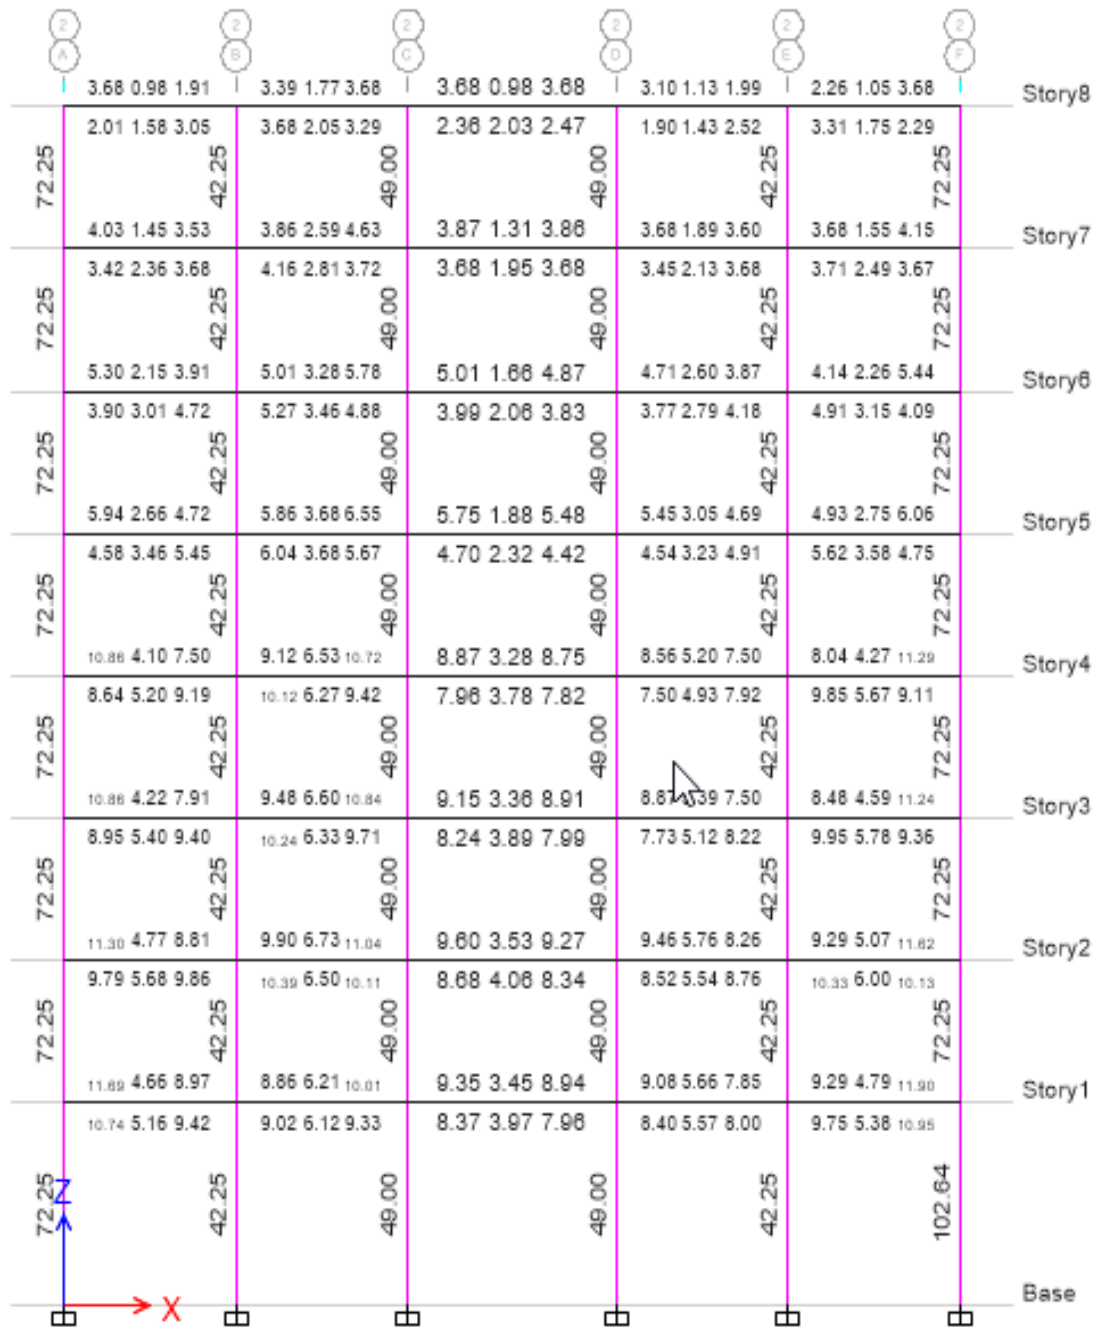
Figura 6 Diseño del acero en elevación de los elementos estructurales (Fuente propia)
